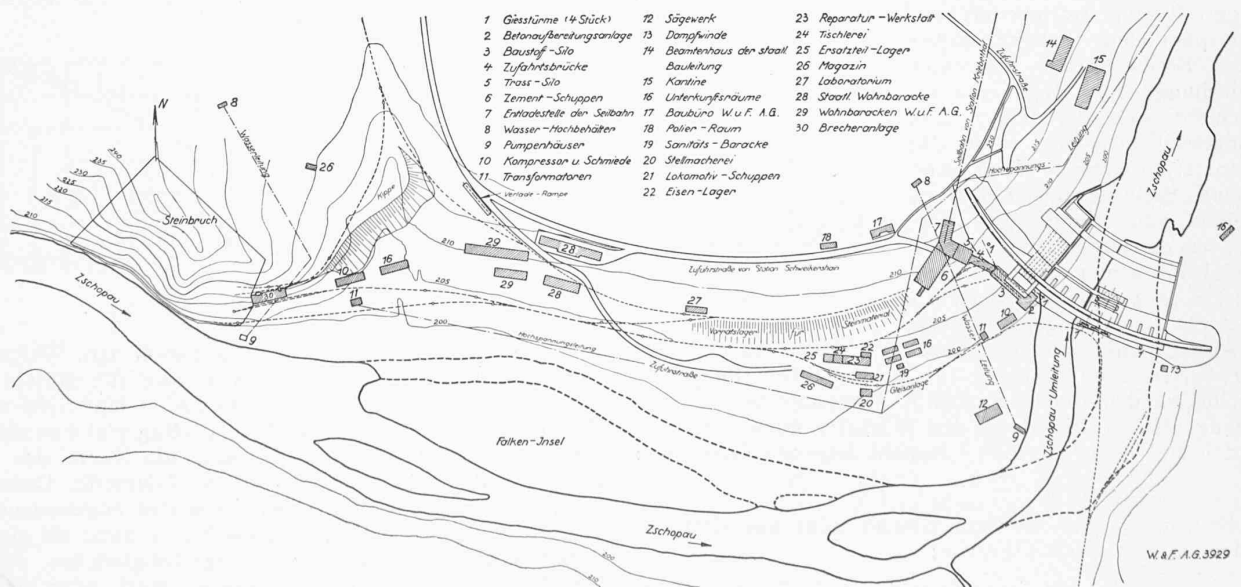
Lageplan der Baustelle, Masstab rund 1 : 5000. (Vergl. die Installationsbauten auf Abb. 10, Seite 190).
